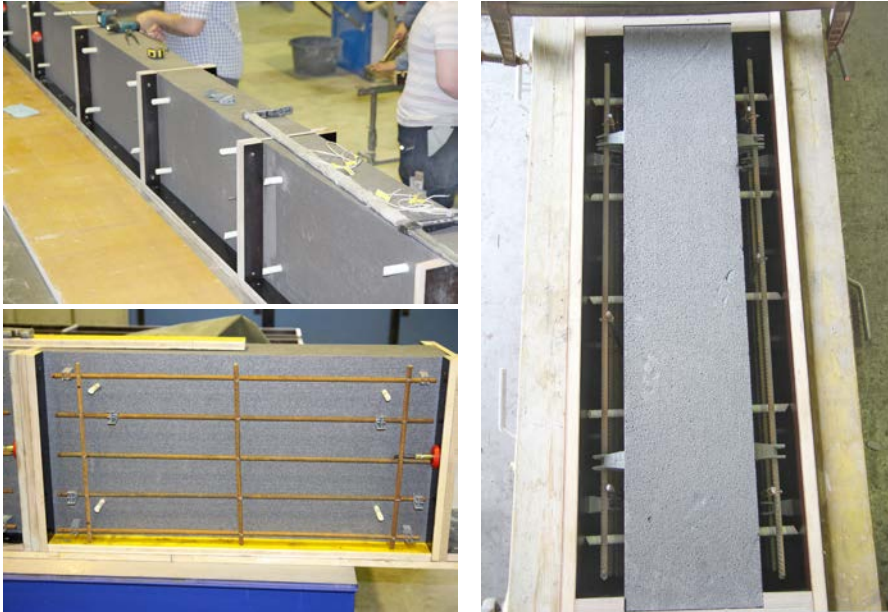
Schalungs- und Bewehrungsvorbereitungen vor der Betonage der Schubversuchskörper
